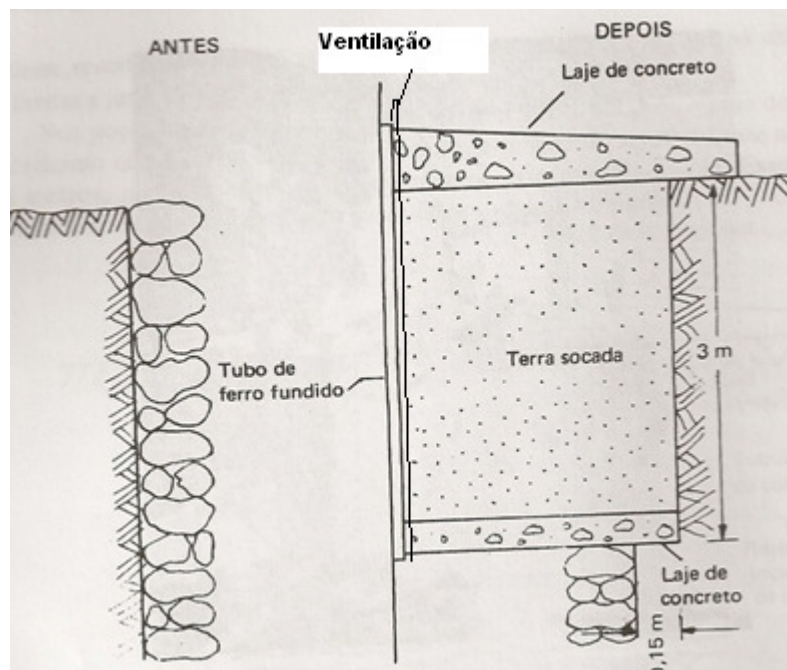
Melhoria do poço com a construção de uma laje para receber terra socada, na espessura de três metros, além da laje de cobertura de concreto armado.
